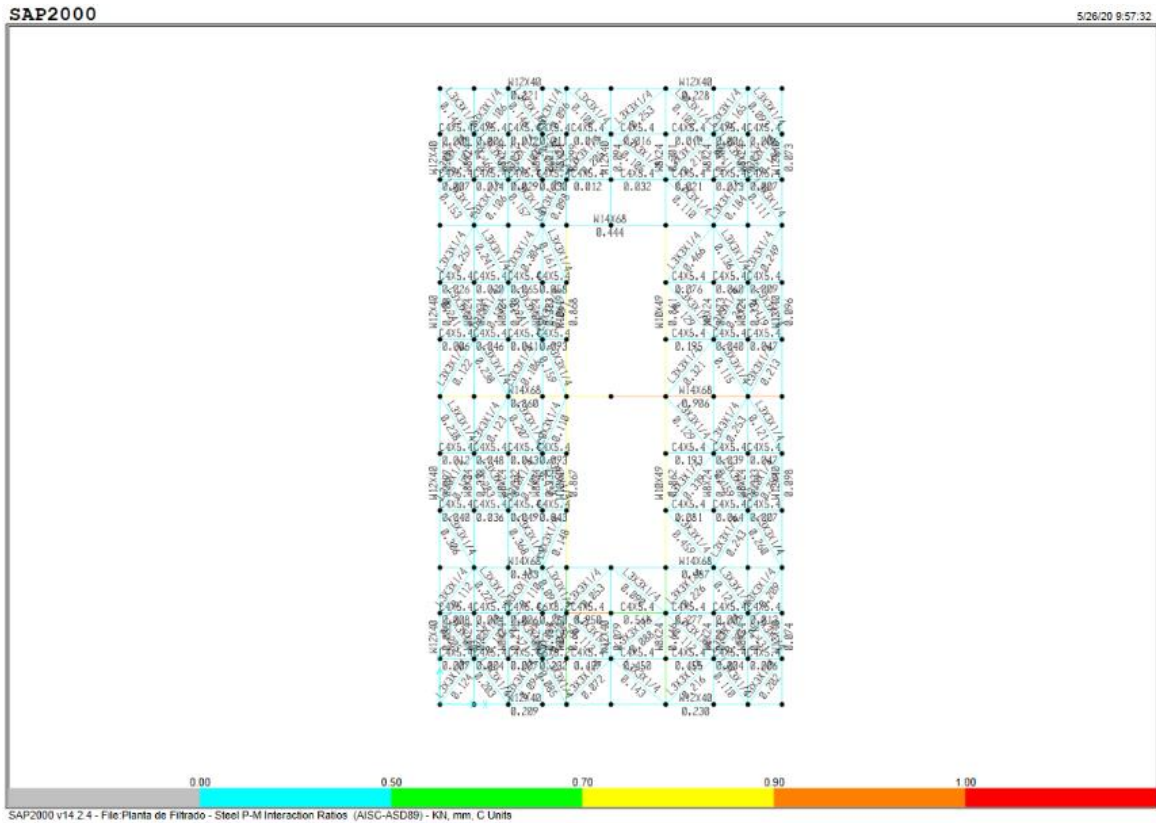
Edificio de Filtrado-Planta Plataforma+189.
